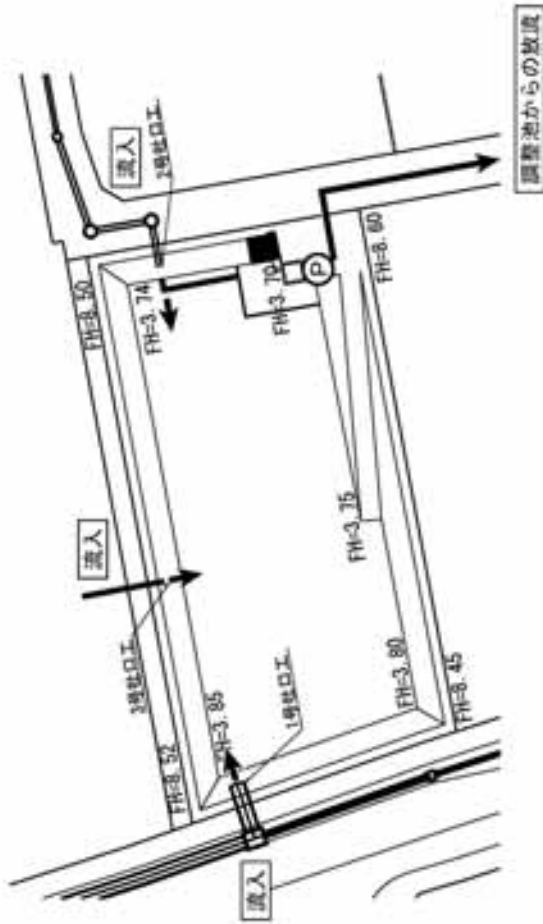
(1) 調整池計画平面・断面図 (第1調整池) 【評価書】
